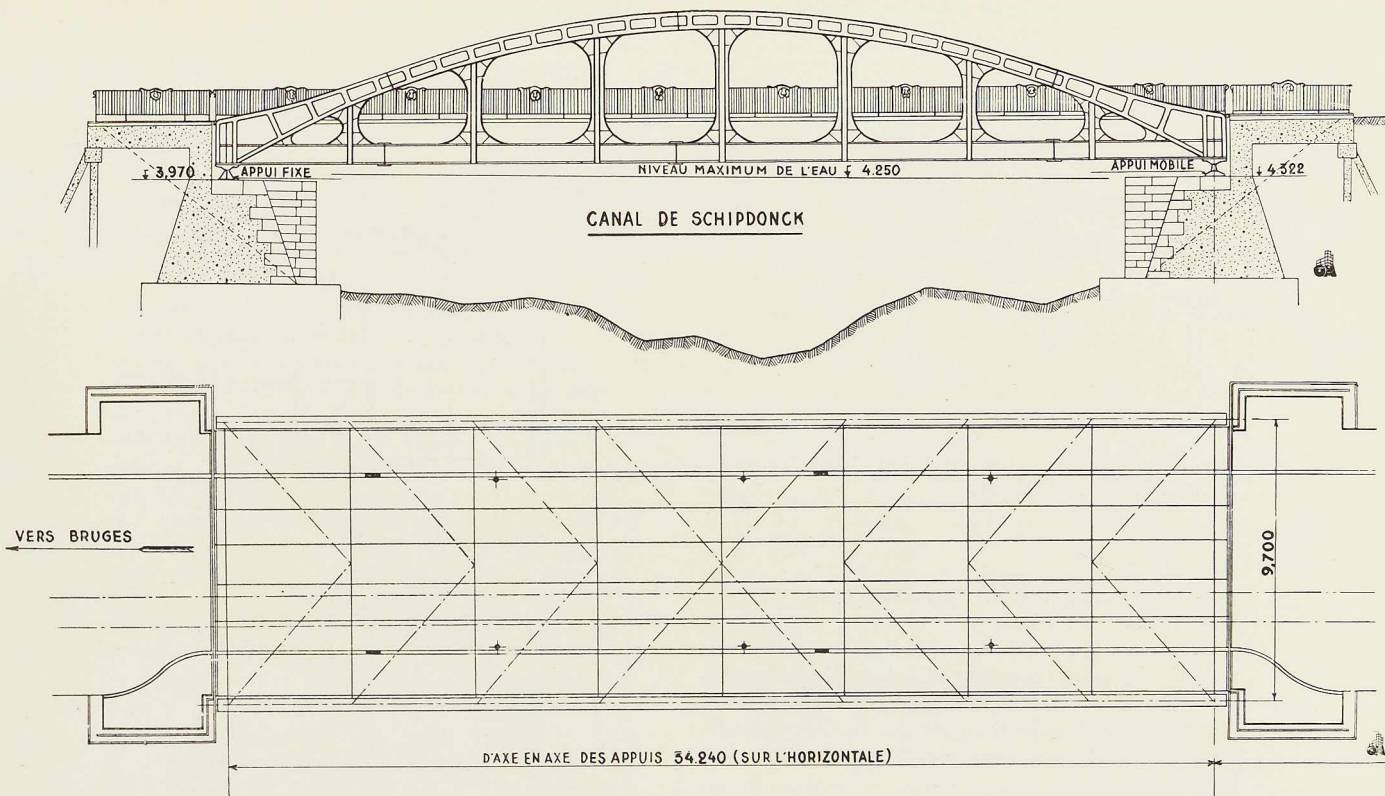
Elévation et vue en plan d'un des ponts de Dudzeele.
